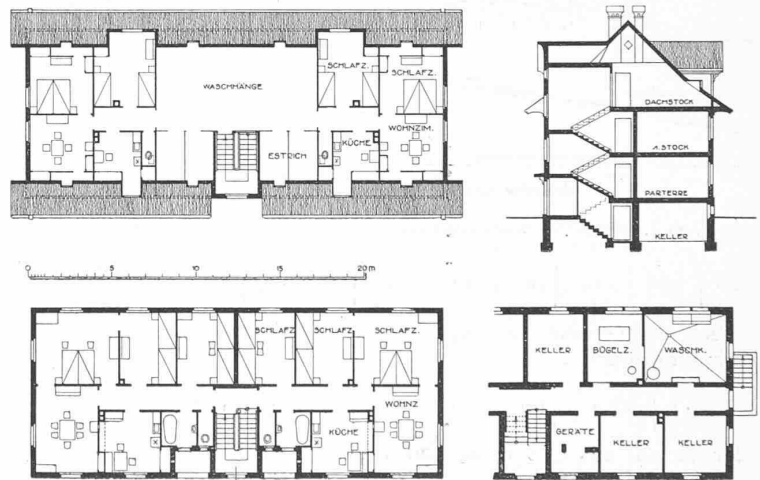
bis 6 Grundrisse, Abb. 7 Schnitt zum Beamtenwohnhaus. — Masstab 1:400.
